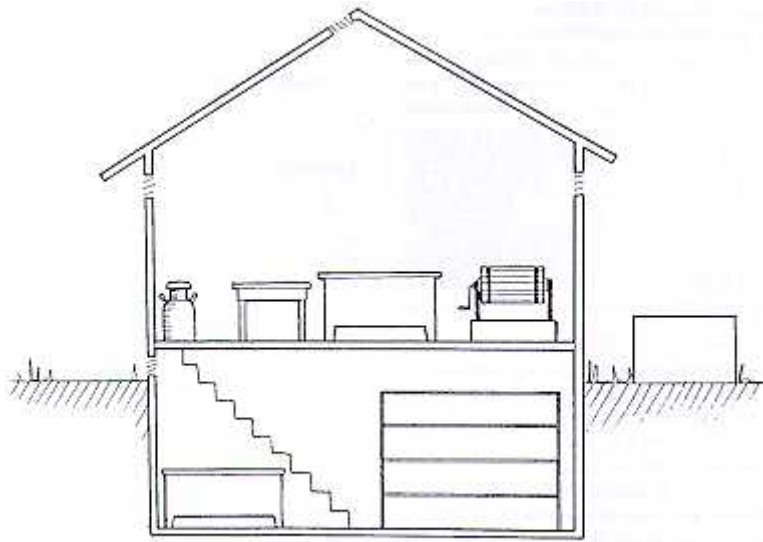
Sección del edificio que muestra la habitación de maduración en la planta baja
